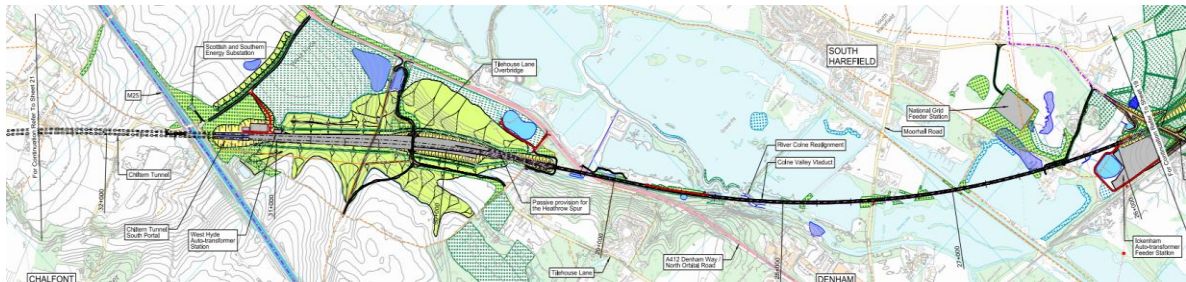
Planta do traçado do viaduto sobre o “Grand Union Canal e Rio Coine” (Unido, Colne Valley viaduct).
